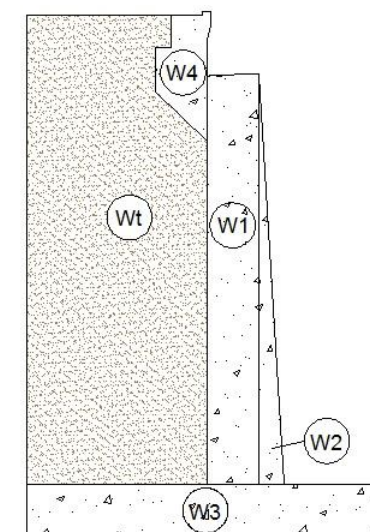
Figura XXI: SECCIÓN PROPUESTA PARA EL ESTRIBO
